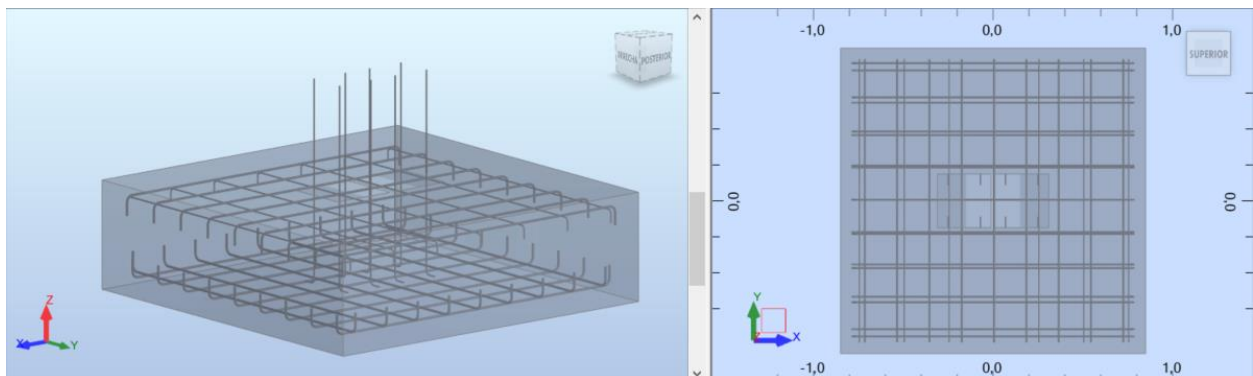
Vista 3D de la armadura para la zapata combinada
